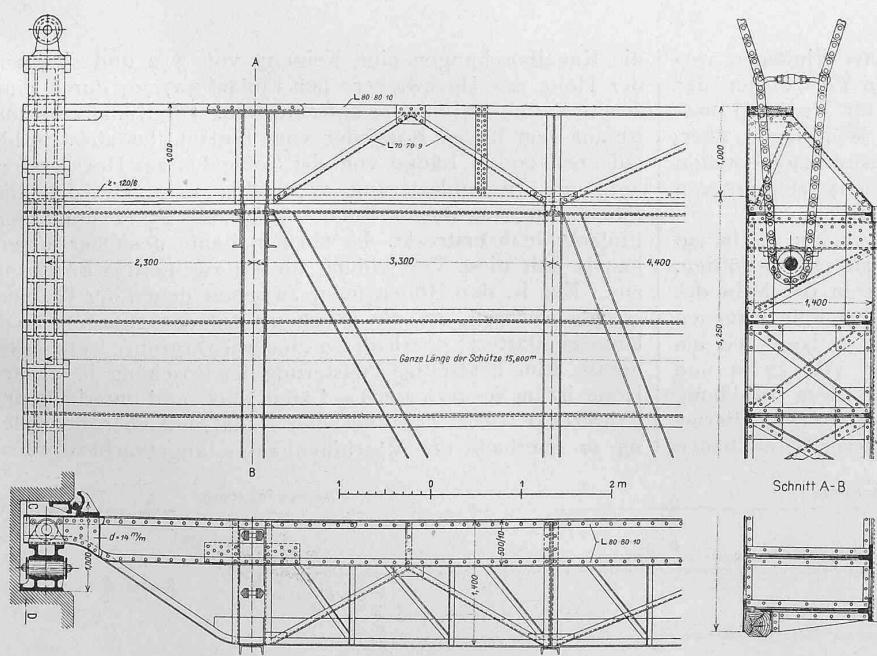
Ansicht, Draufsicht und Querschnitt einer Wehrschütze. — Masstab 1:75.
